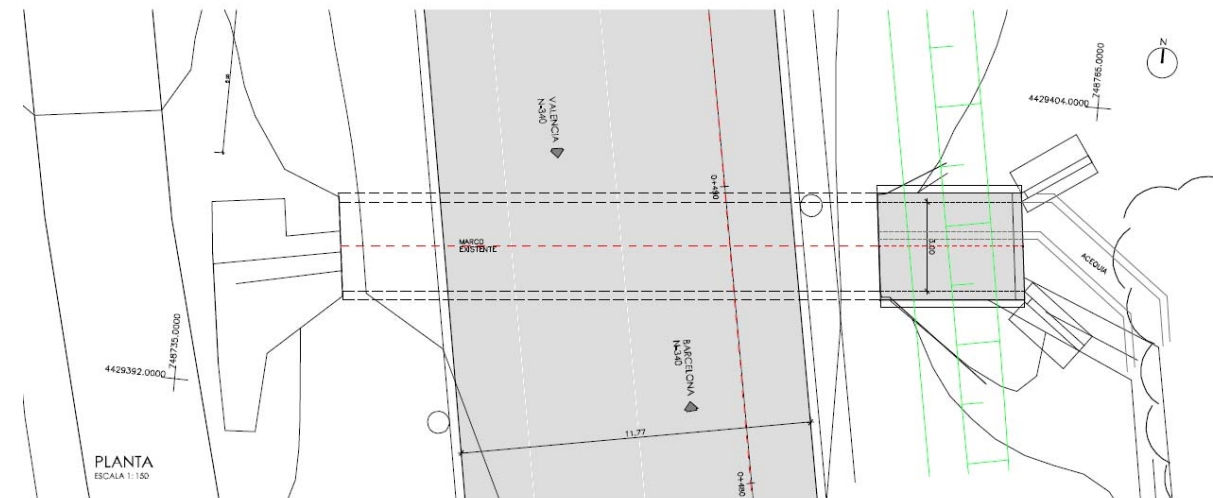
Planta Ampliación Marco Carril de trenzado P.K. 0+488
